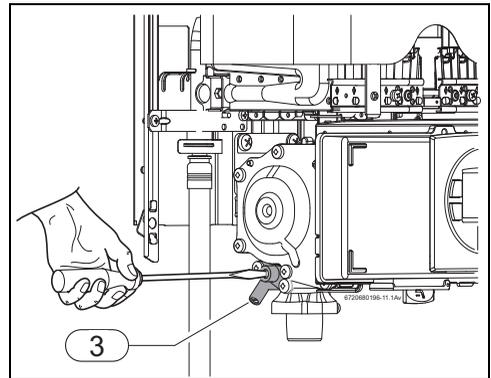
Tornillo de ajuste del caudal máximo de gas
